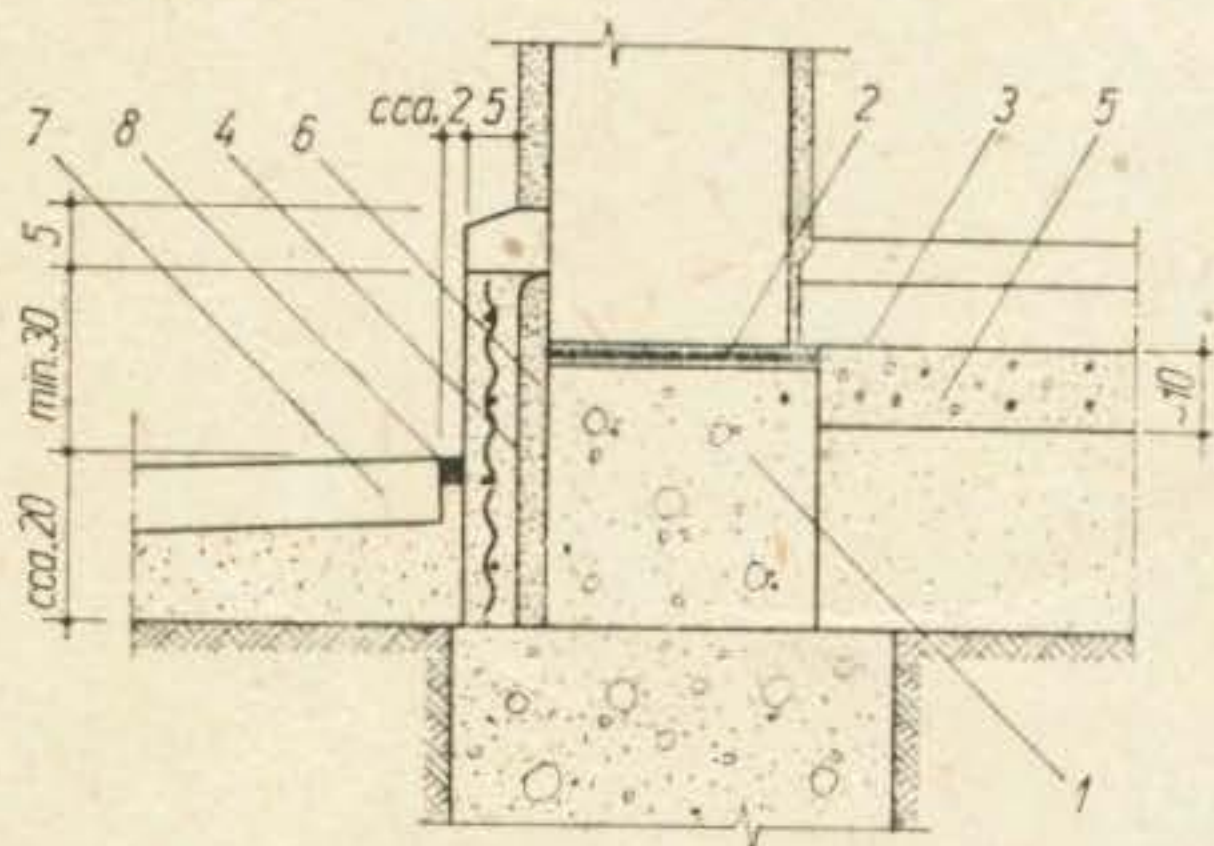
Hidroizolarea orizontală a pereților exteriori la construcții fără subsol:
